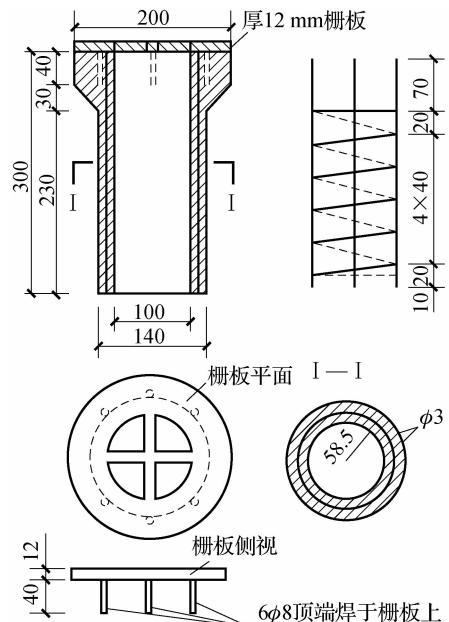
钢筋混凝土泄水管(尺寸单位:mm)
